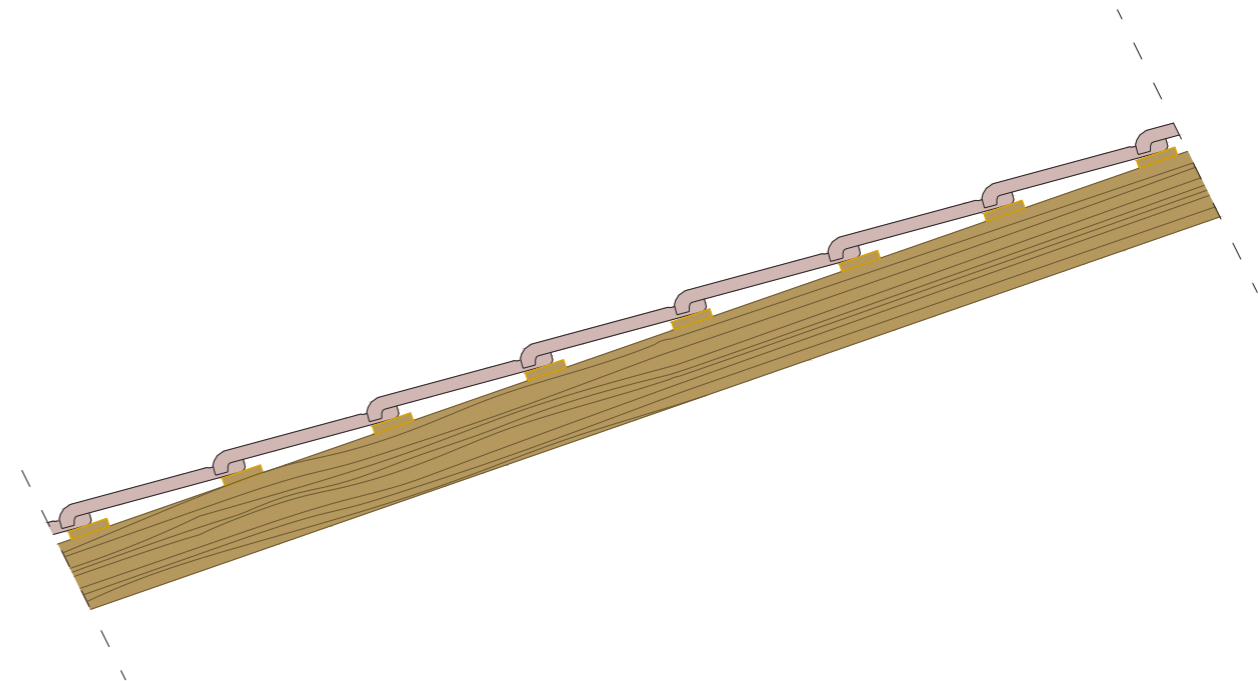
Tramo de cubierta con teja apoyada directamente sobre las correas de madera.
